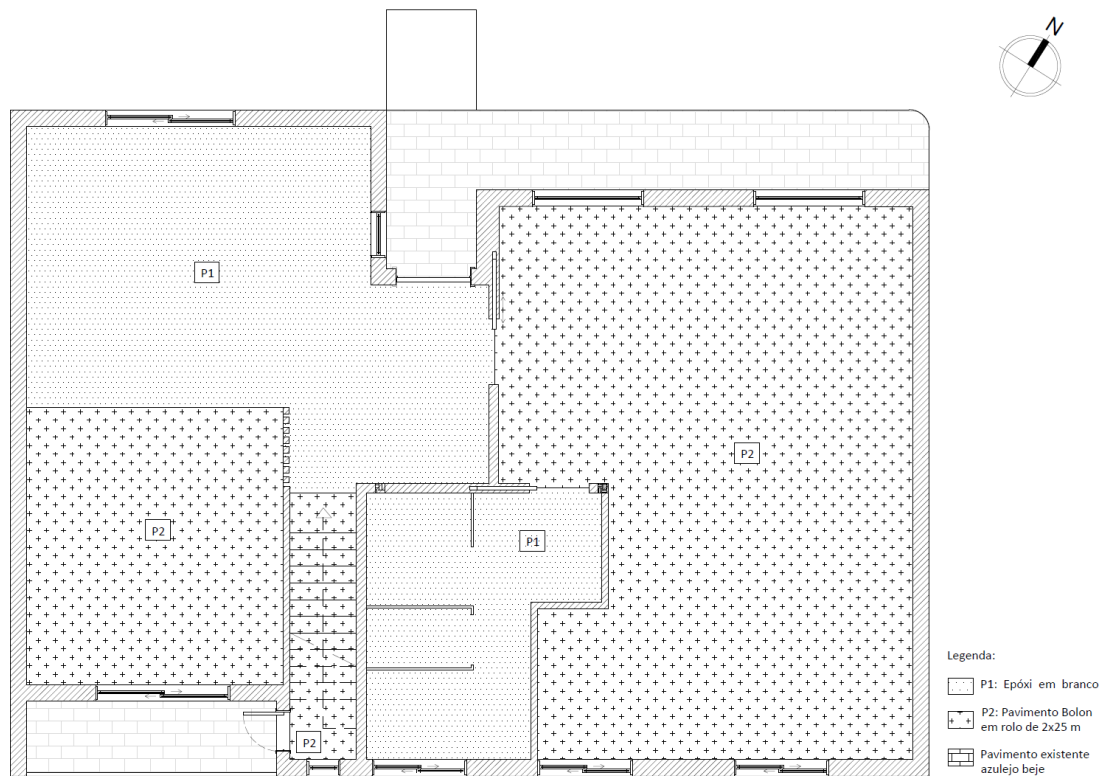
Planta de pavimento piso 1. Fonte: Marisa Francisco.
